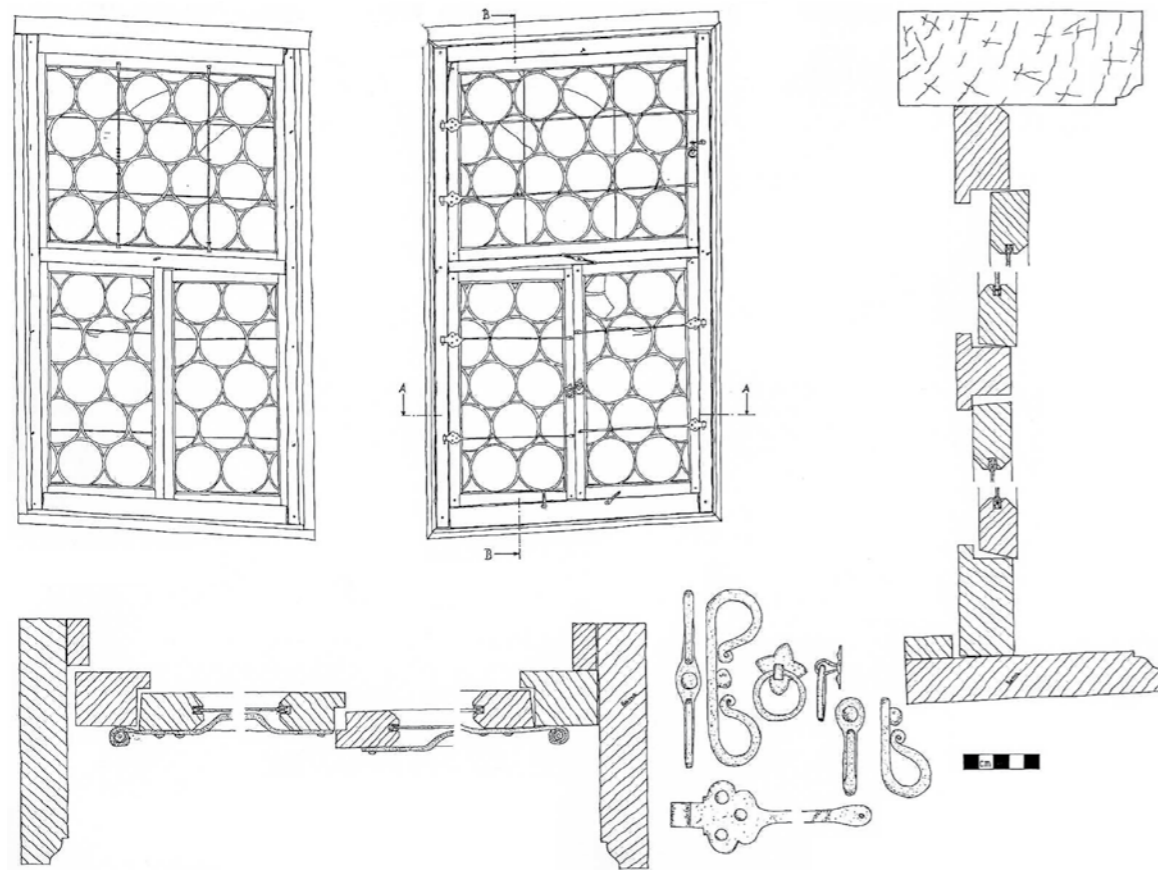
Nördlingen, Polizeigasse 20, „Mötzel'sches Haus“, erbaut 1634: Ein bauzeitlicher Fensterbestand ist einschließlich der Verglasung vollständig erhalten.
